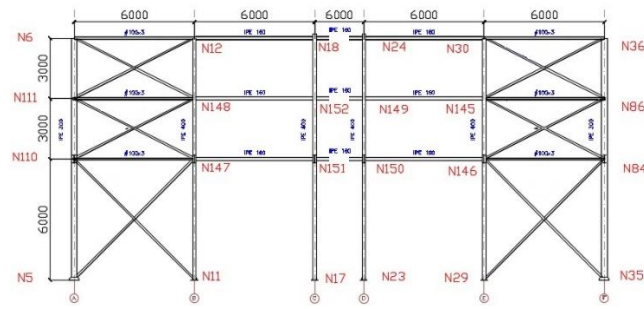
Fachada lateral menor dimensión. (Fuente: Creación propia)
